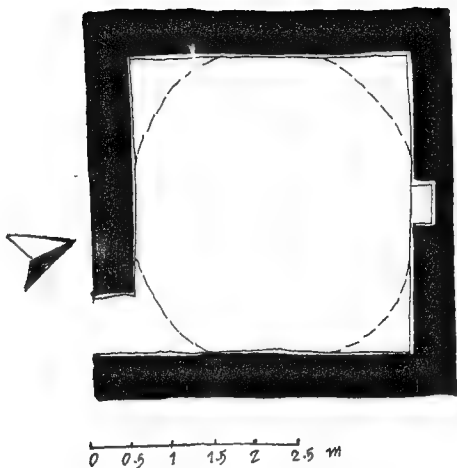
ضريح الحاج اسماعيل - مسقط الفقى
